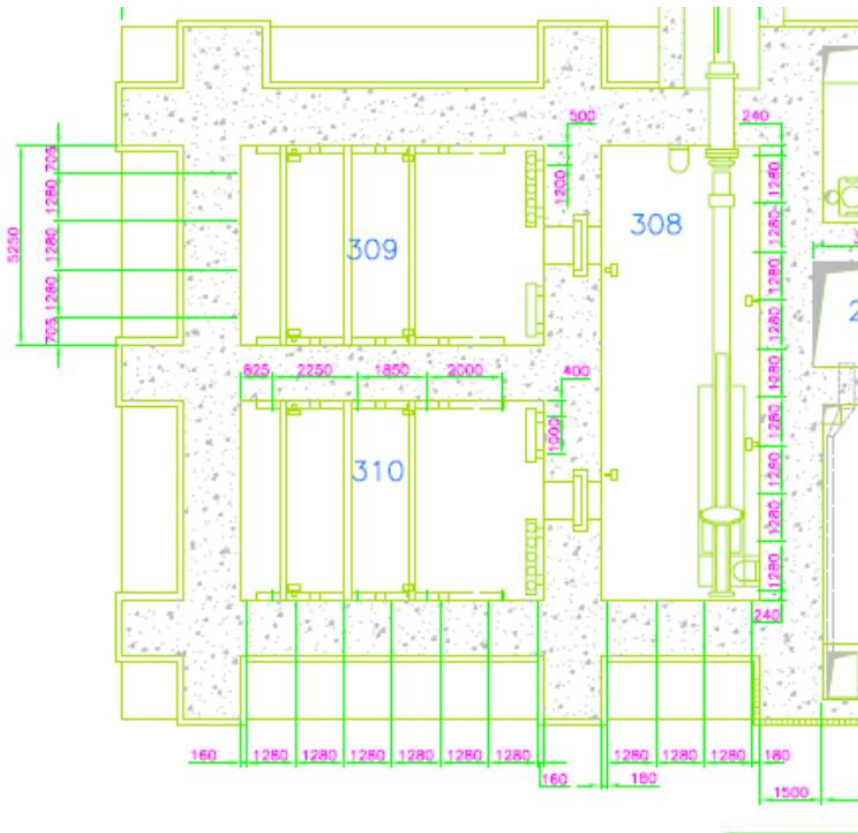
Casa de Piletas 1 de Atucha I (Plano M13-31)
